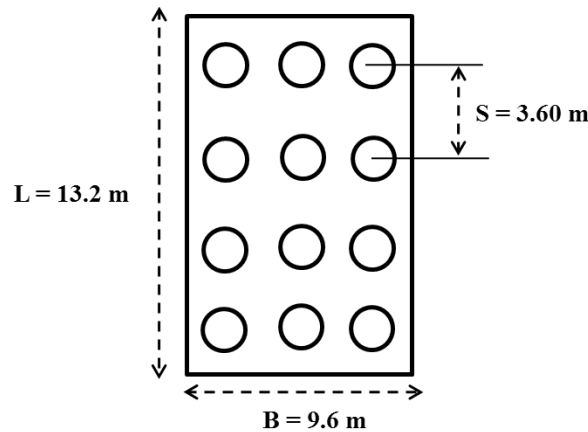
Schéma de conception de semelle pour la Pile 04.
